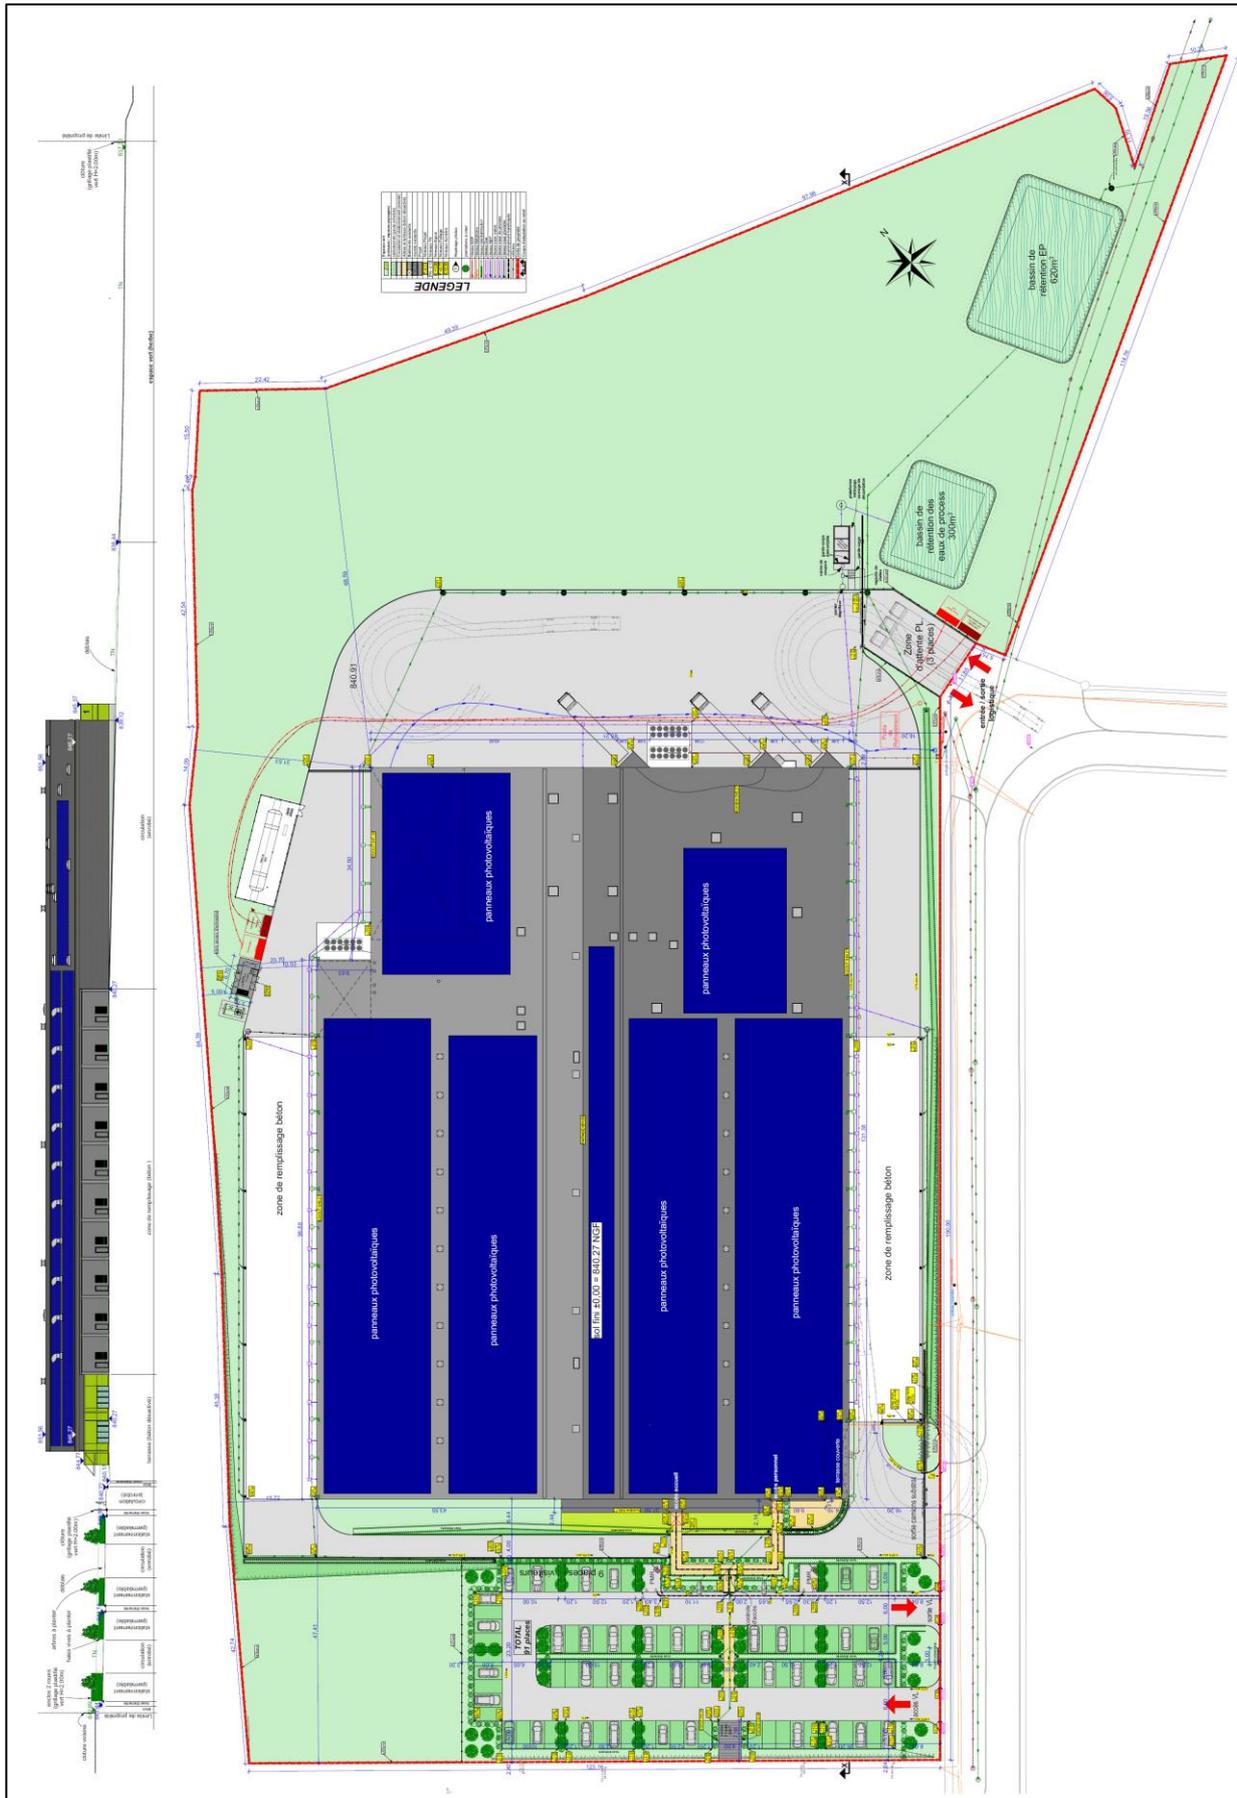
Plan masse du projet (source : Tricot Architecte)
